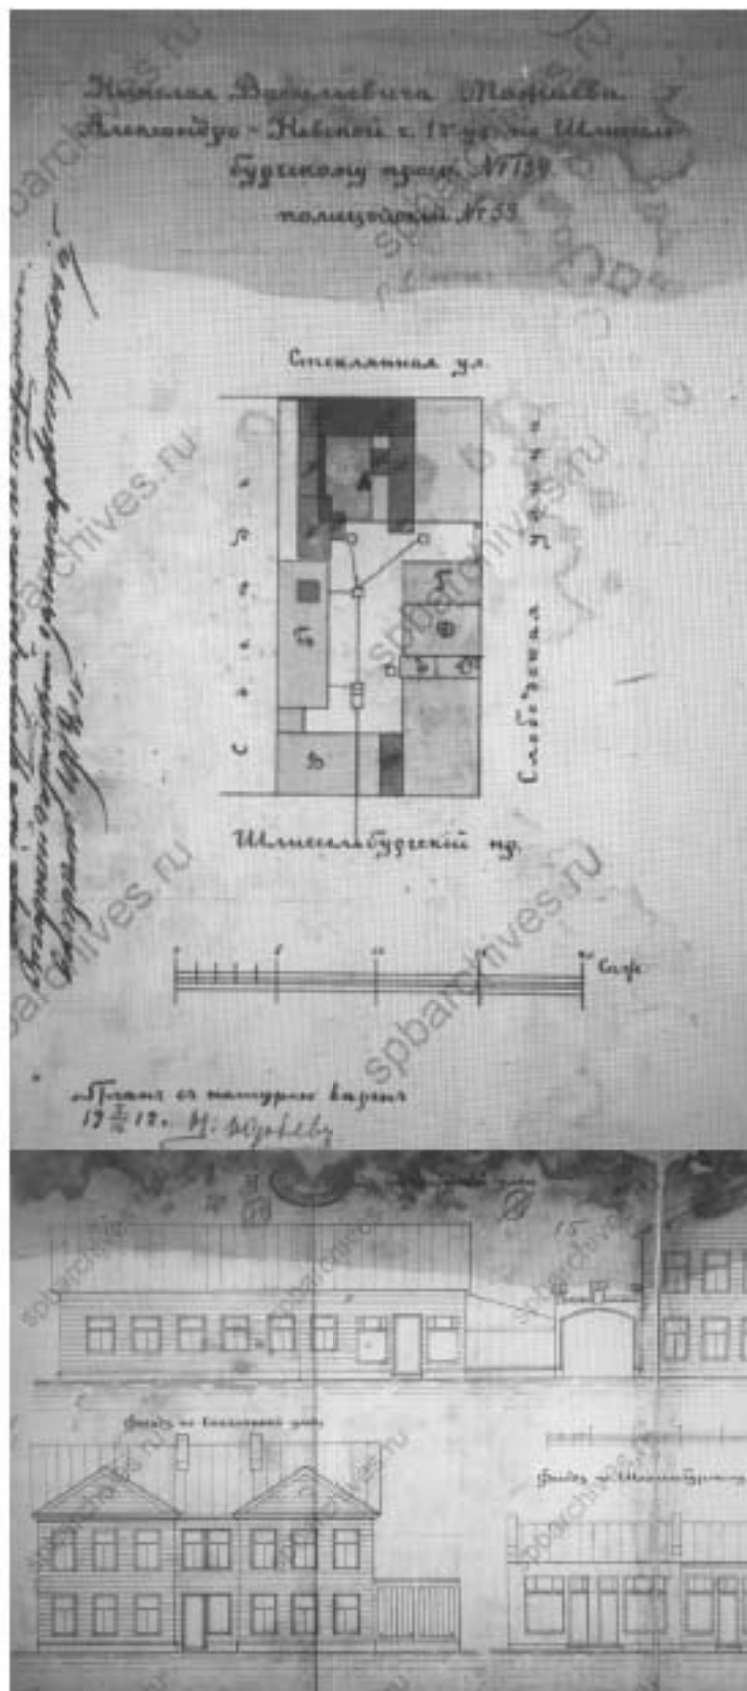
План участка, фасад здания по адресу Стеклоплавильная ул.,26/Слободская ул.,2/Шлиссельбургский пр.,53
